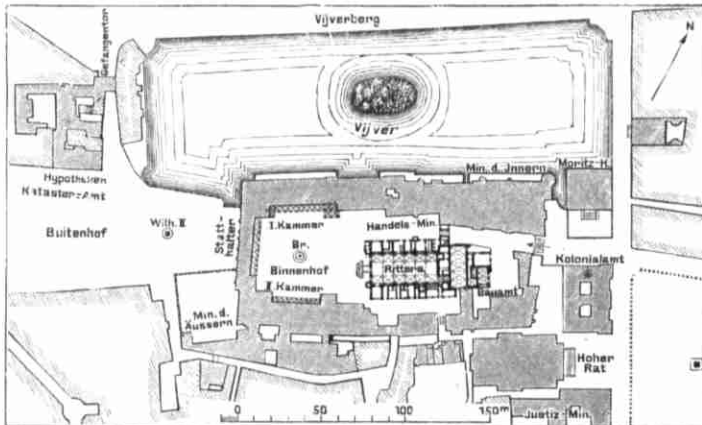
Binnenhof. Lageplan und Grundriß im Jahre 1891.
